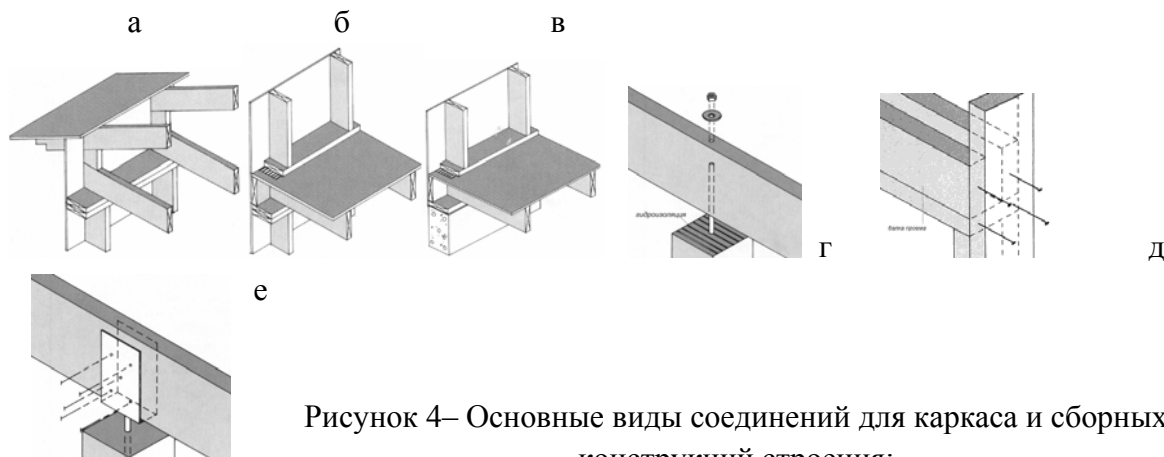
Основные виды соединений для каркаса и сборных конструкций строения:
